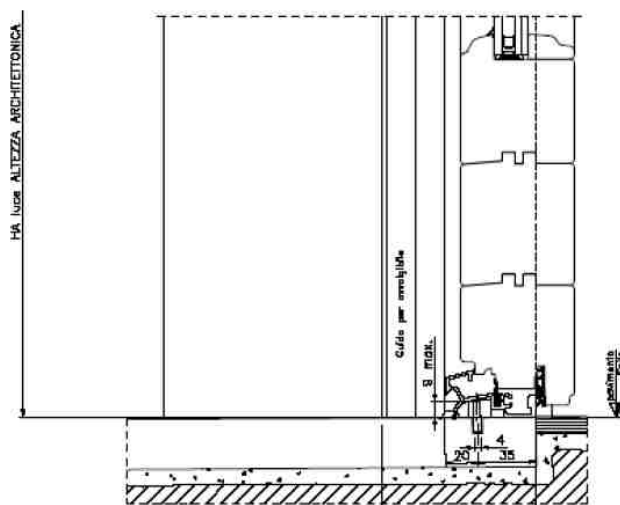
Dettaglio della battuta inferiore dell'infisso (porta-finestra)
